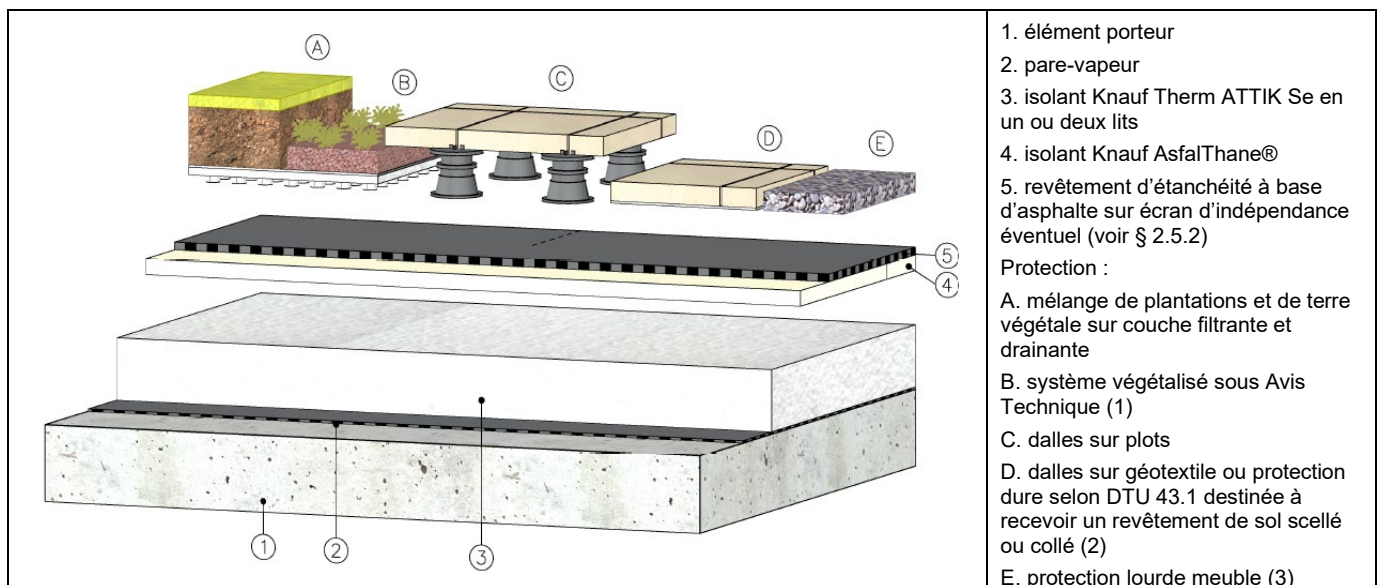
Exemple de toiture-terrasse avec élément porteur en maçonnerie, Knauf Thane ET Se + Knauf AsfalThane® sous revêtement d'étanchéité en asphalte et protection lourde
